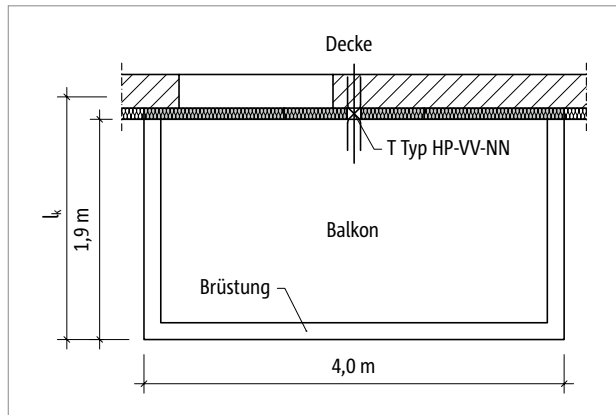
Schöck Isokorb® T Typ KL, HP: Grundriss
